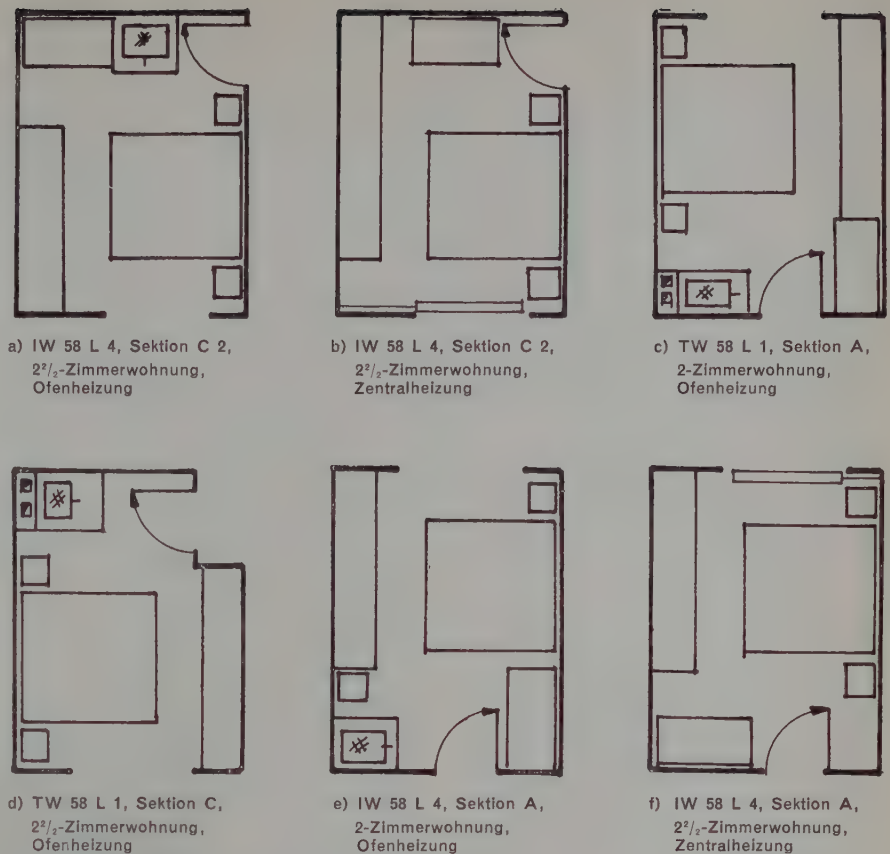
Beispiele für den Schrankwandeinbau im Schlafzimmer einiger Typengrundrisse 1:100
